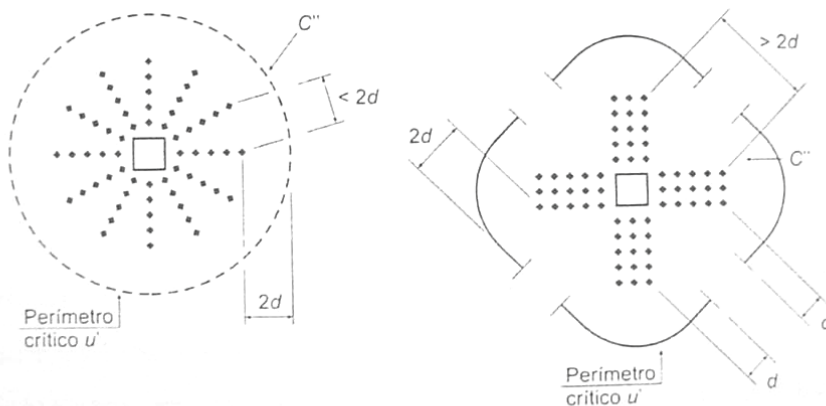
Disposição da armadura de punção em planta e contorno da superfície crítica C
